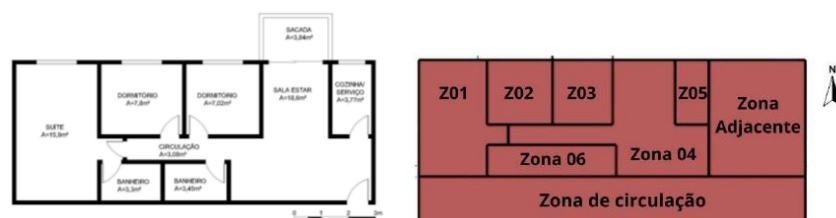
Planta Inicial e Arquétipo Simulado. Fonte: Telles (2016) e Autora (2025).
